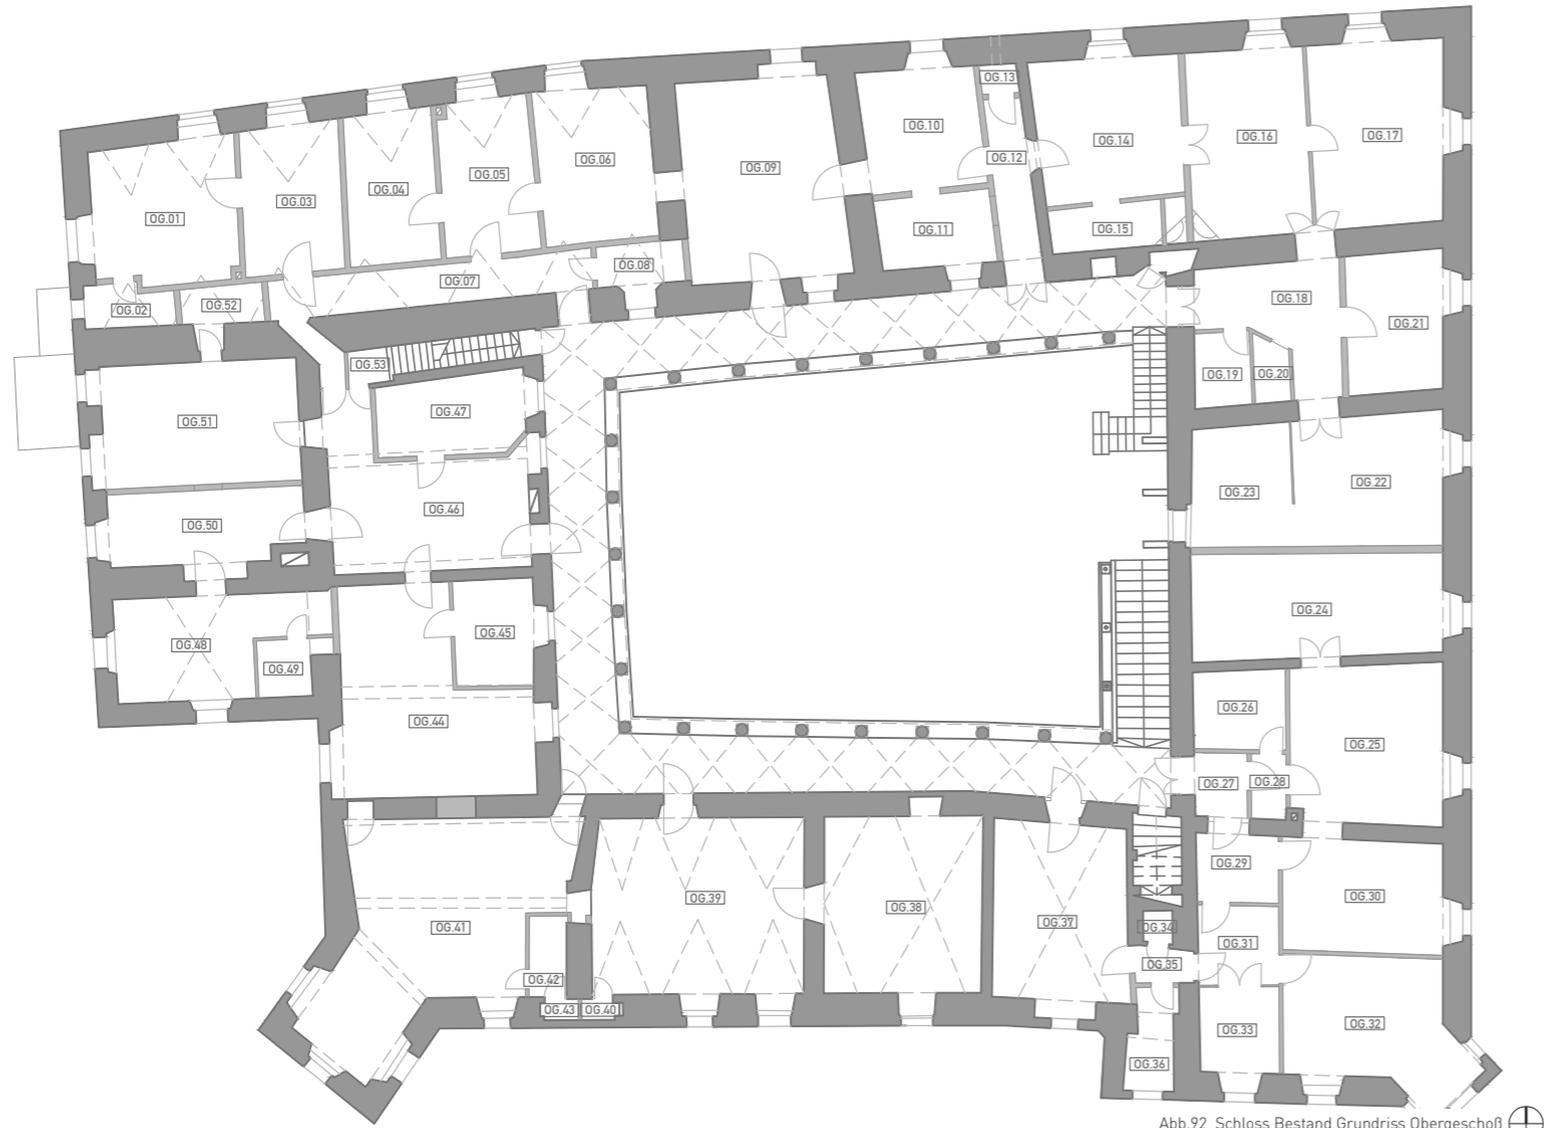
Schloss Bestand Grundriss Obergeschoß
